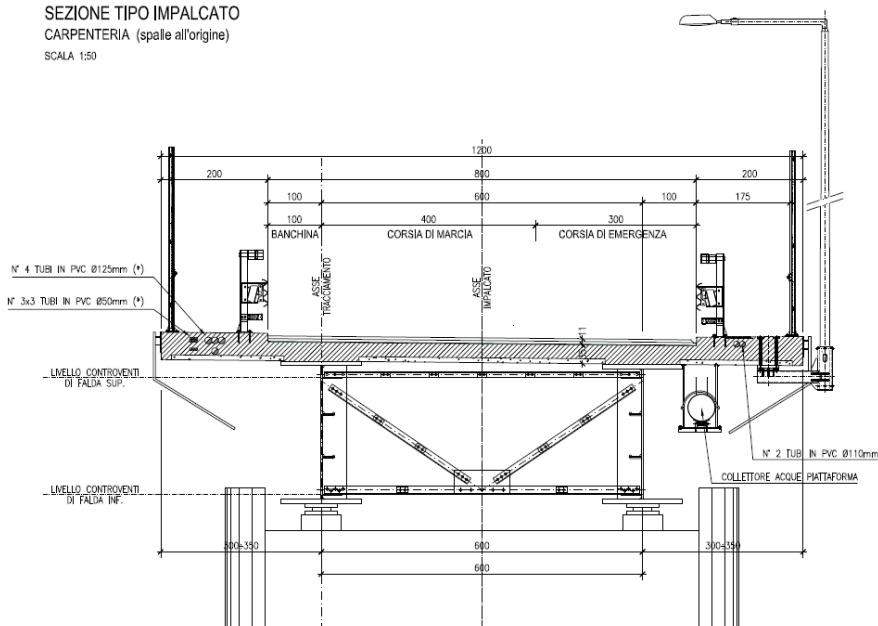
SEZIONI TIPO PER IMPALCATO MISTO ACCIAIO – CALCESTRUZZO PER RAMPE DI INTERCONNESSIONE E SVINCOLO
